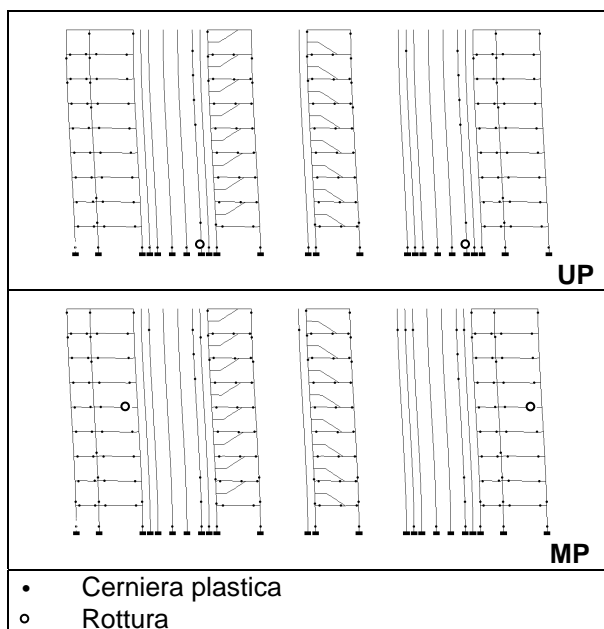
Struttura con travi a ginocchio sconnesse e pilastri rinforzati: Deformate in dir.y
